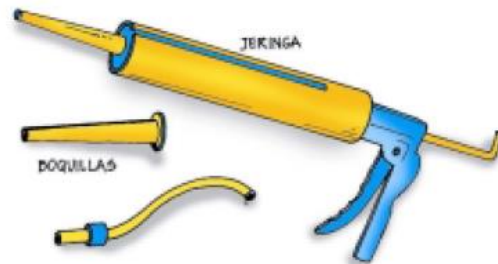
Equipos – Inyección de Grietas con Epóxico.
